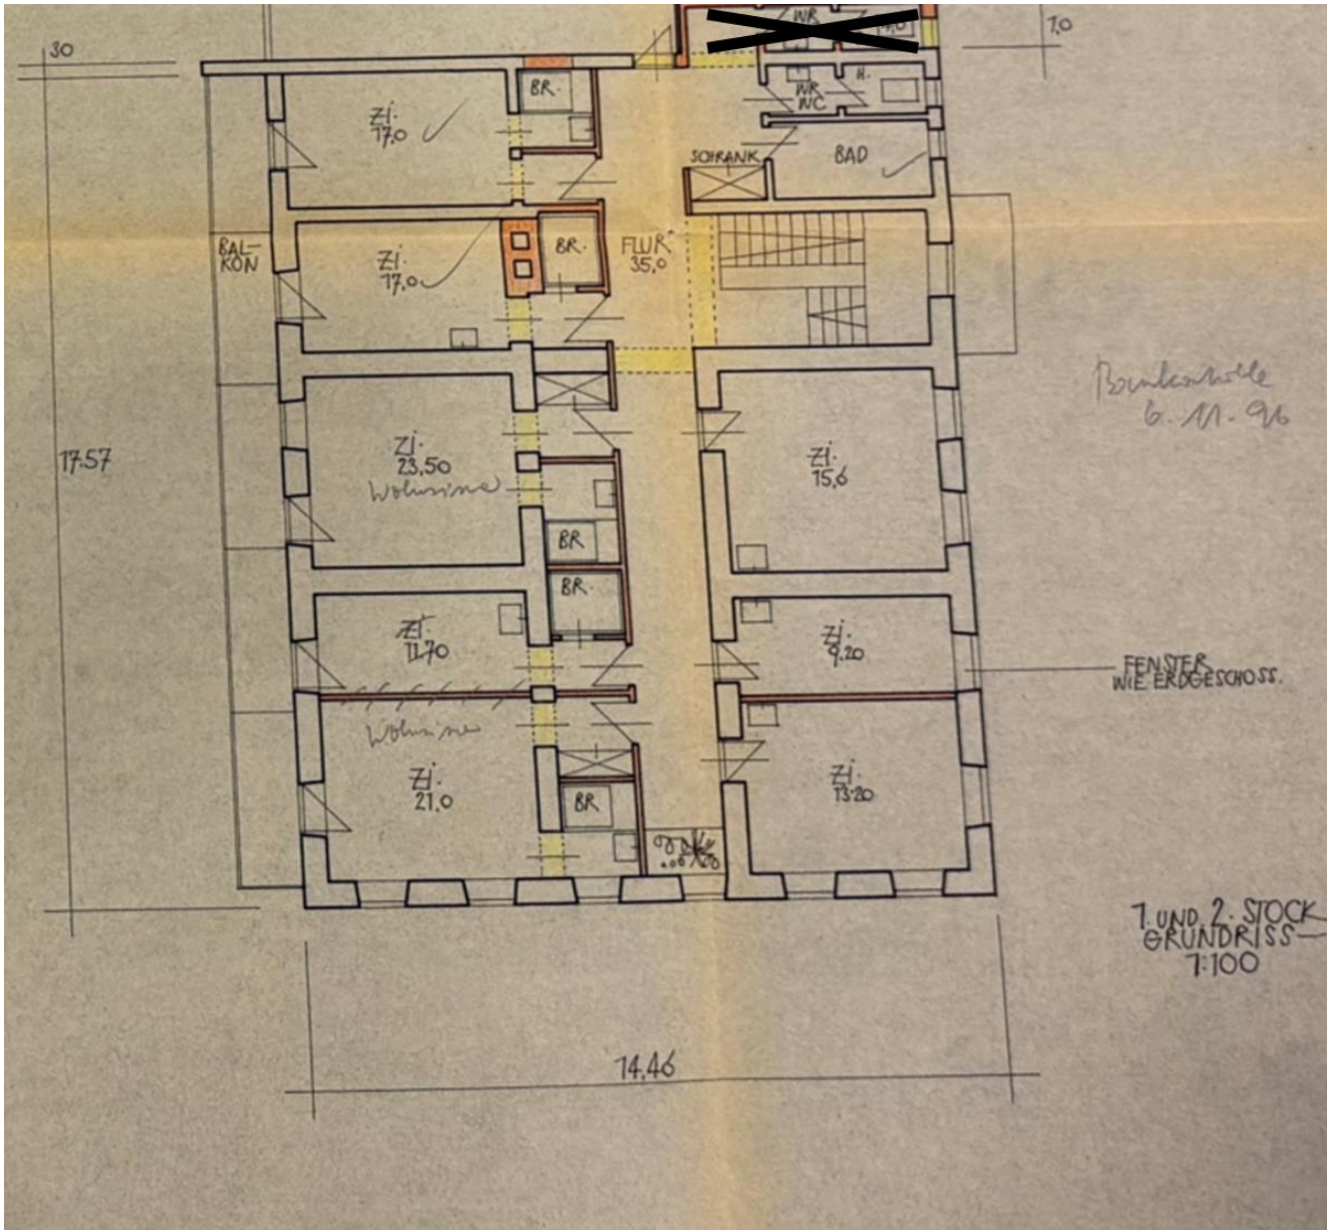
Grundriss 1. & 2. Obergeschoss (1967)
